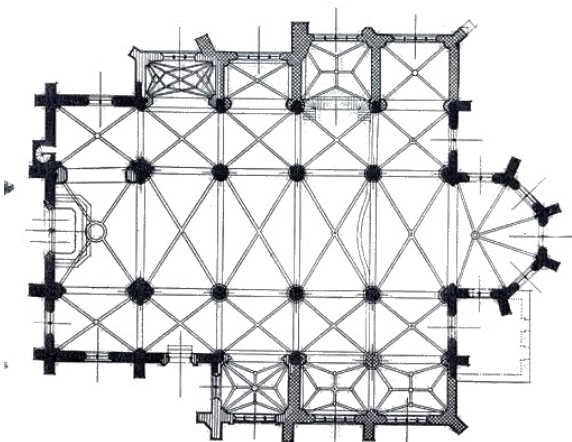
St-Hubert, St-Pierre-et-Paul, Grundriss
